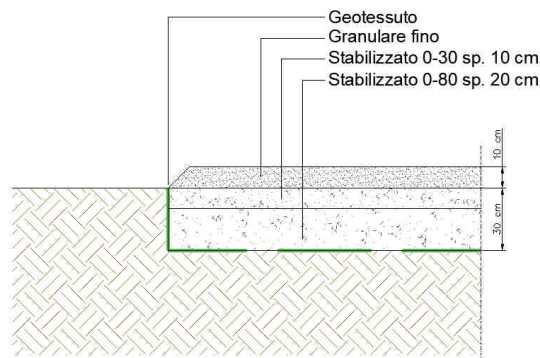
sezione tipo viabilità interna all'impianto e piazzali.
